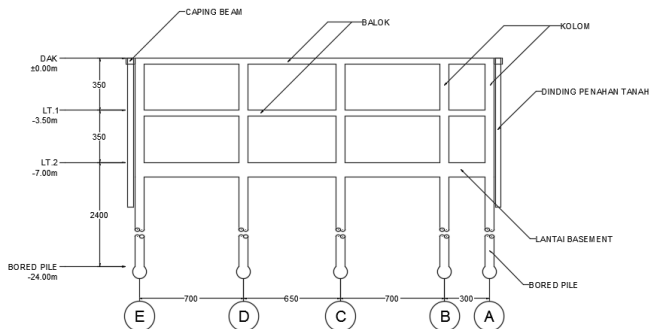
Gambar Layout Rencana Konstruksi
